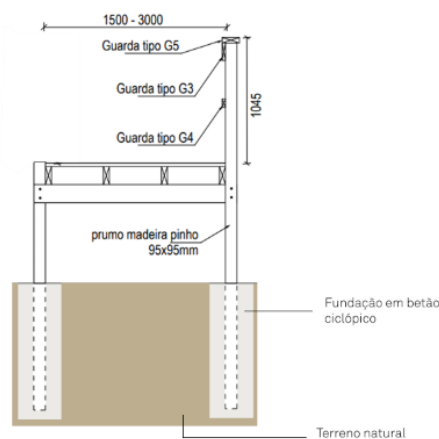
Alçado da estrutura de apoio no percurso sobrelevado com medidas (milímetros).
